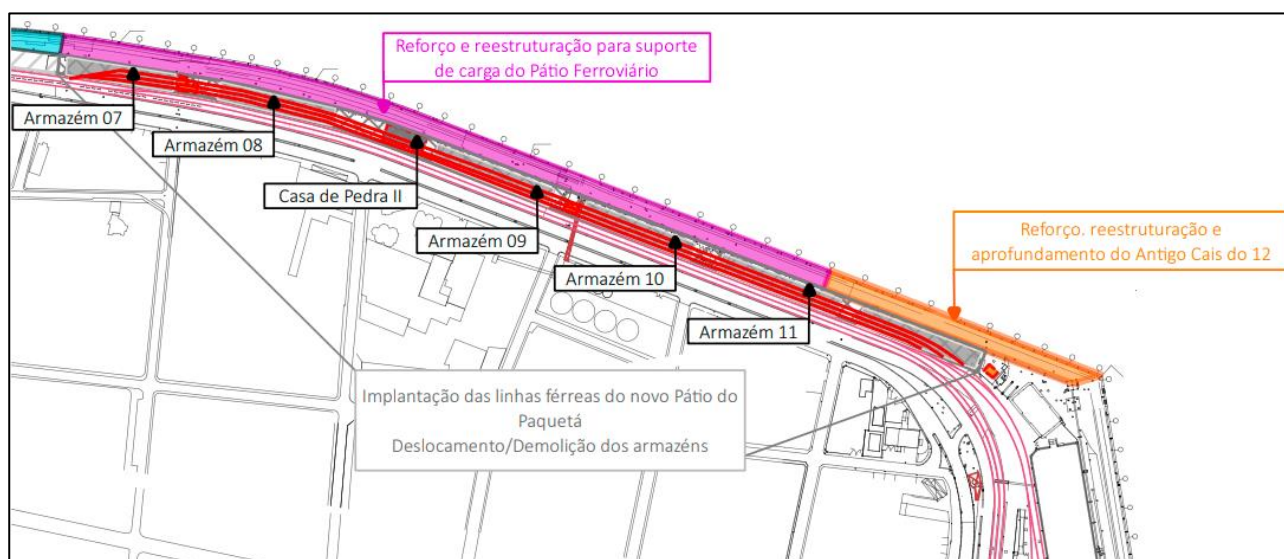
Localização das estruturas e indicação das obras de reforço.
